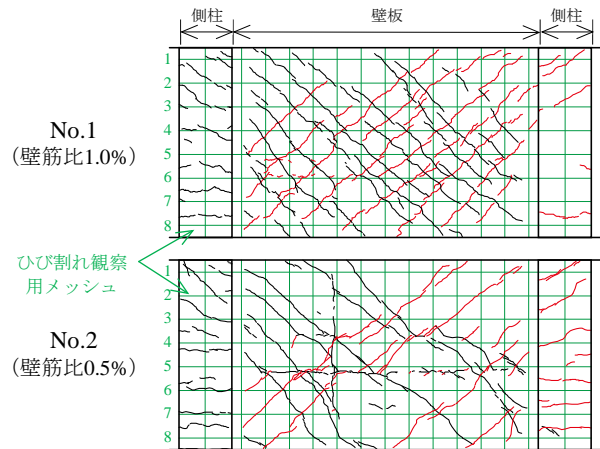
変形角+0.3%におけるひび割れ状況
